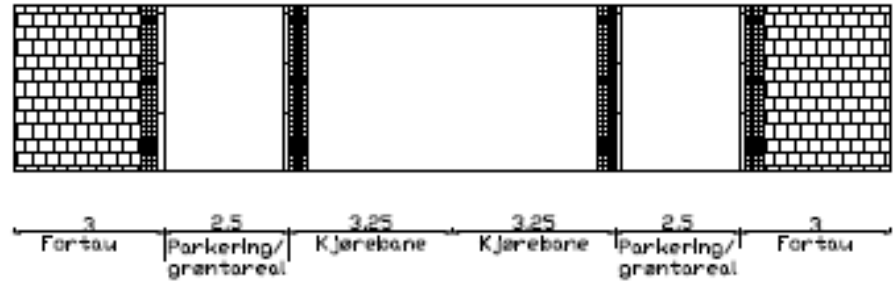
viser plass for parkering. Belegning i asfalt i kjørebane, kantstein av naturstein, linjer og rammer i gatestein. Parkeringsarealet belegges med asfalt. Fortau belagt med betongheller.
